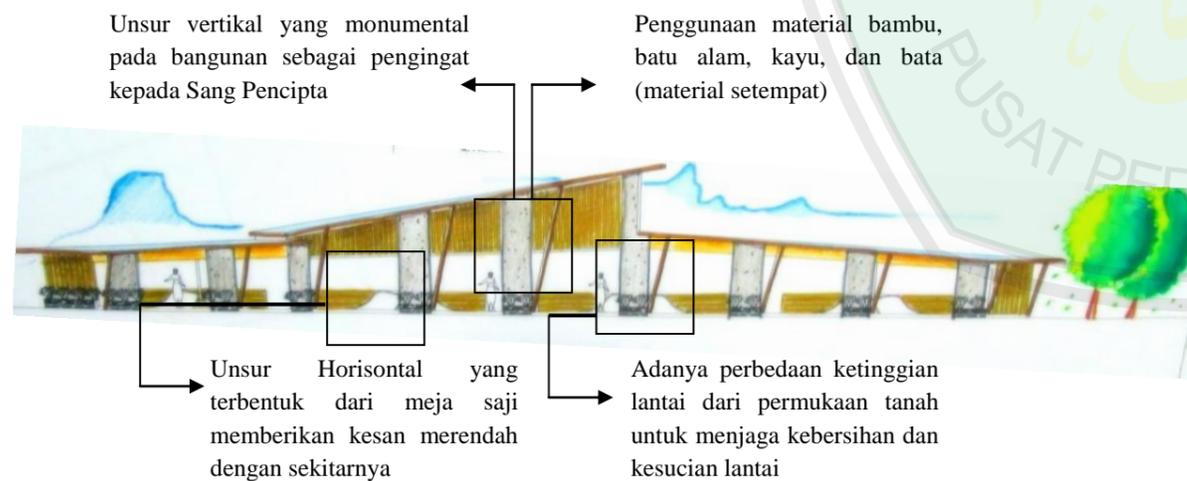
Denah Pusat Kuliner dan Oleh-Oleh 1
